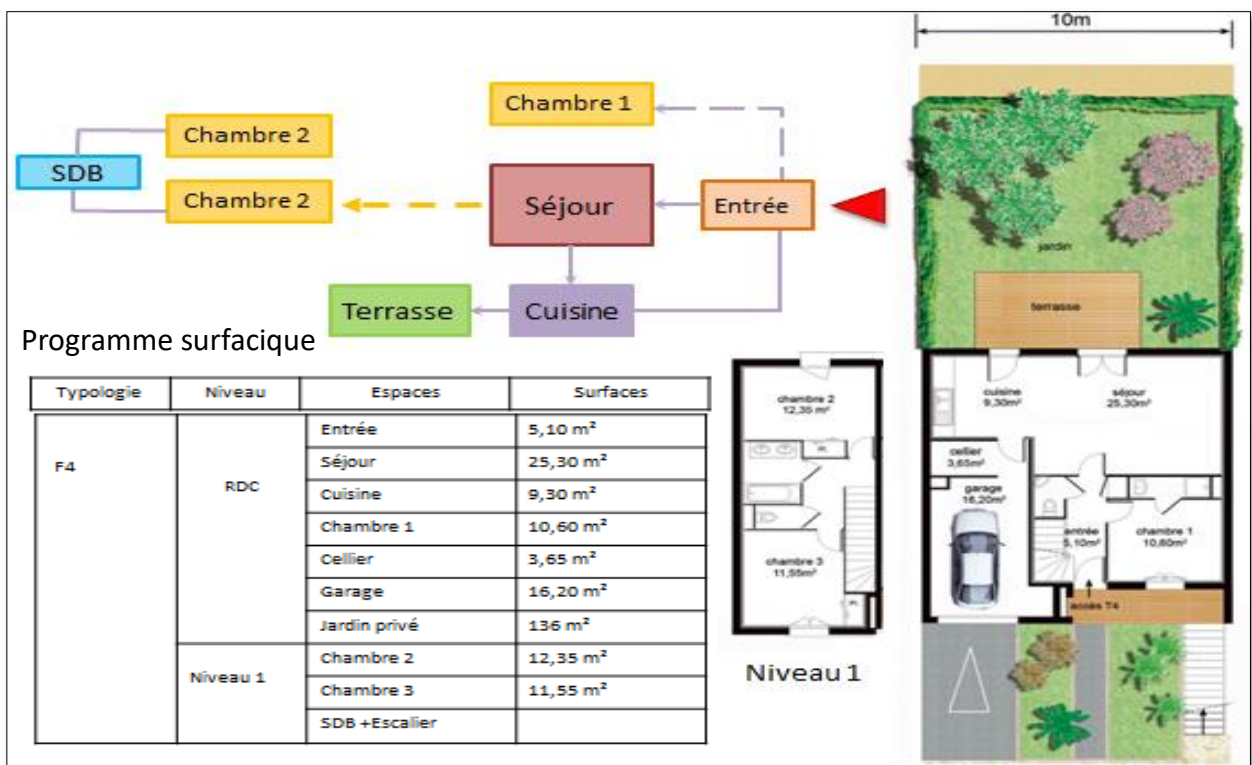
Plan du logement f4 au 1^{er} étage source : auteur
